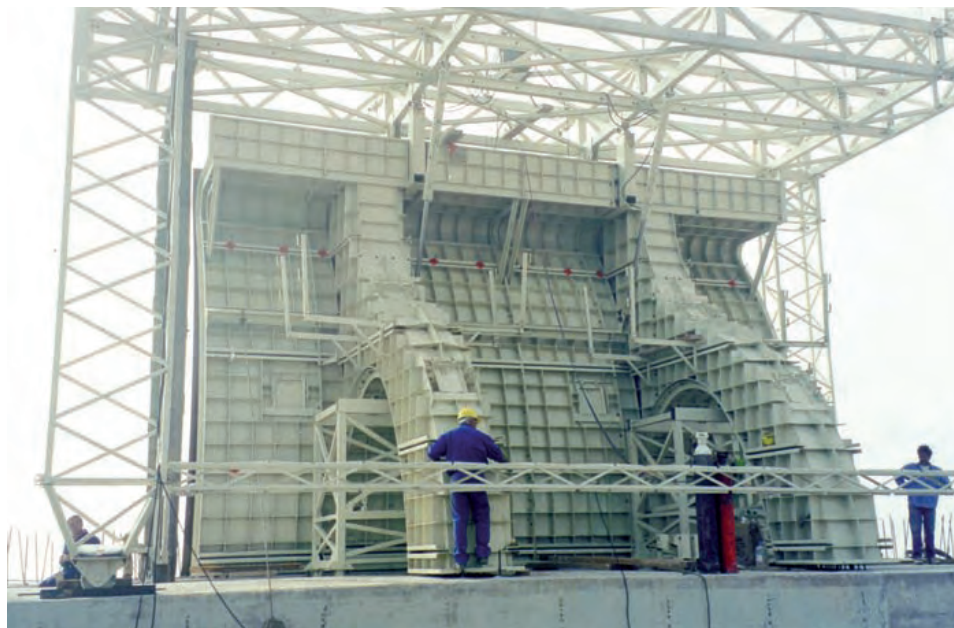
C Encofrado de espaldón de hormigón armado
